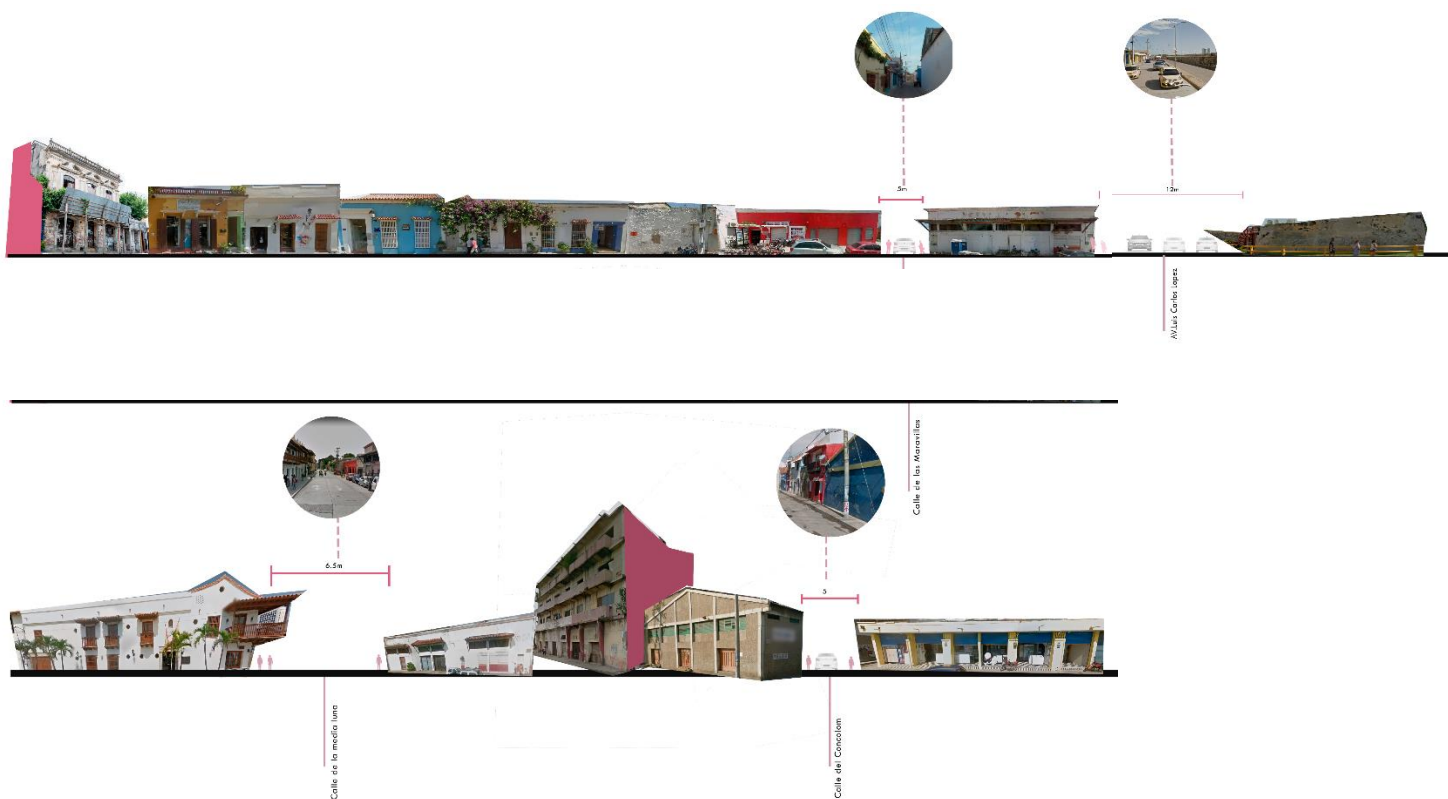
Perfil a nivel de Fachada. Nota. Fuente propia
